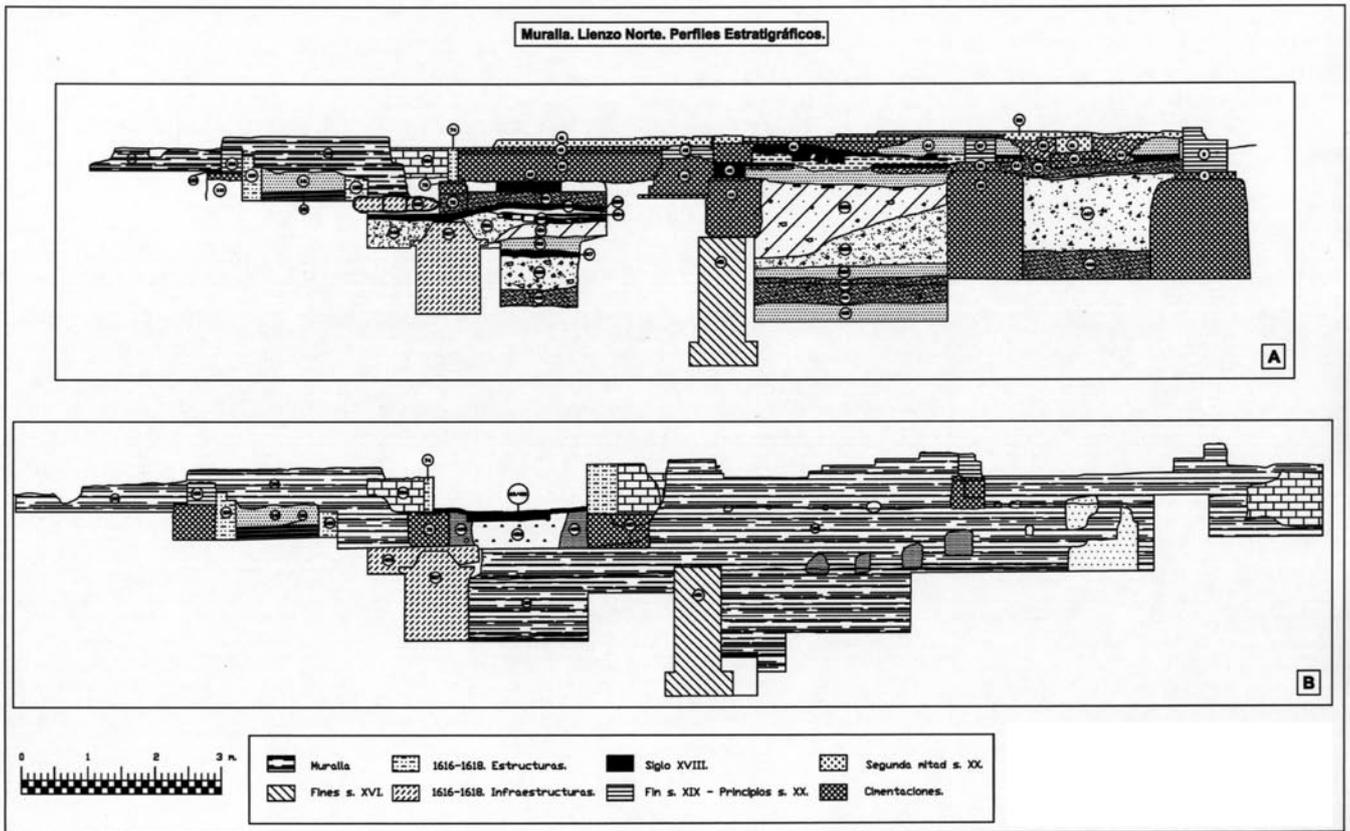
Muralla. Lienzo norte. Estratigrafías y estructuras adosadas antes y después de su excavación.
